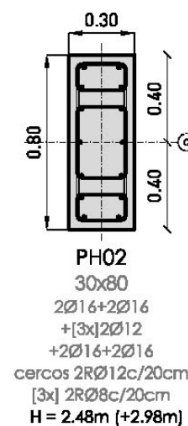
Pilar 02 Casa Balint. Fuente: David Gallardo.
